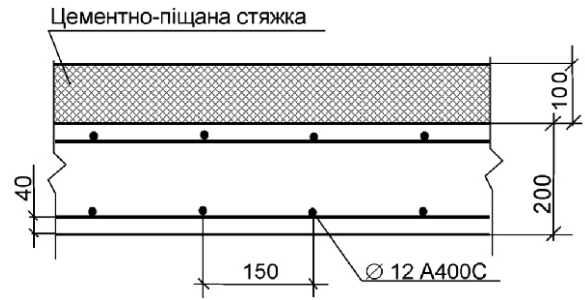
Схема перерізу плити перекриття у місці між стіною та ригелем та розташування арматури у ньому
